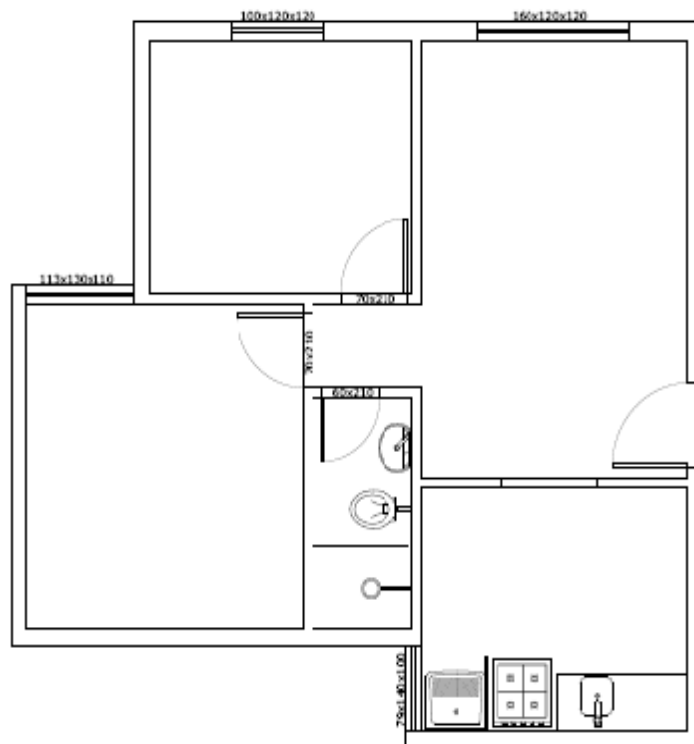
Planta baixa do apartamento do Residencial Atalaia.
